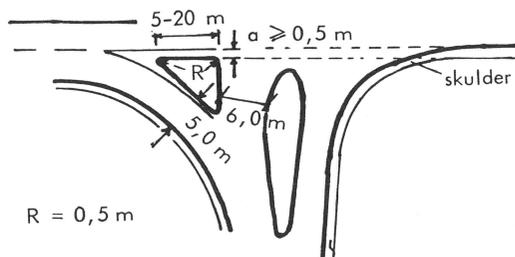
Utforming av parallellformet høyresvingfelt
